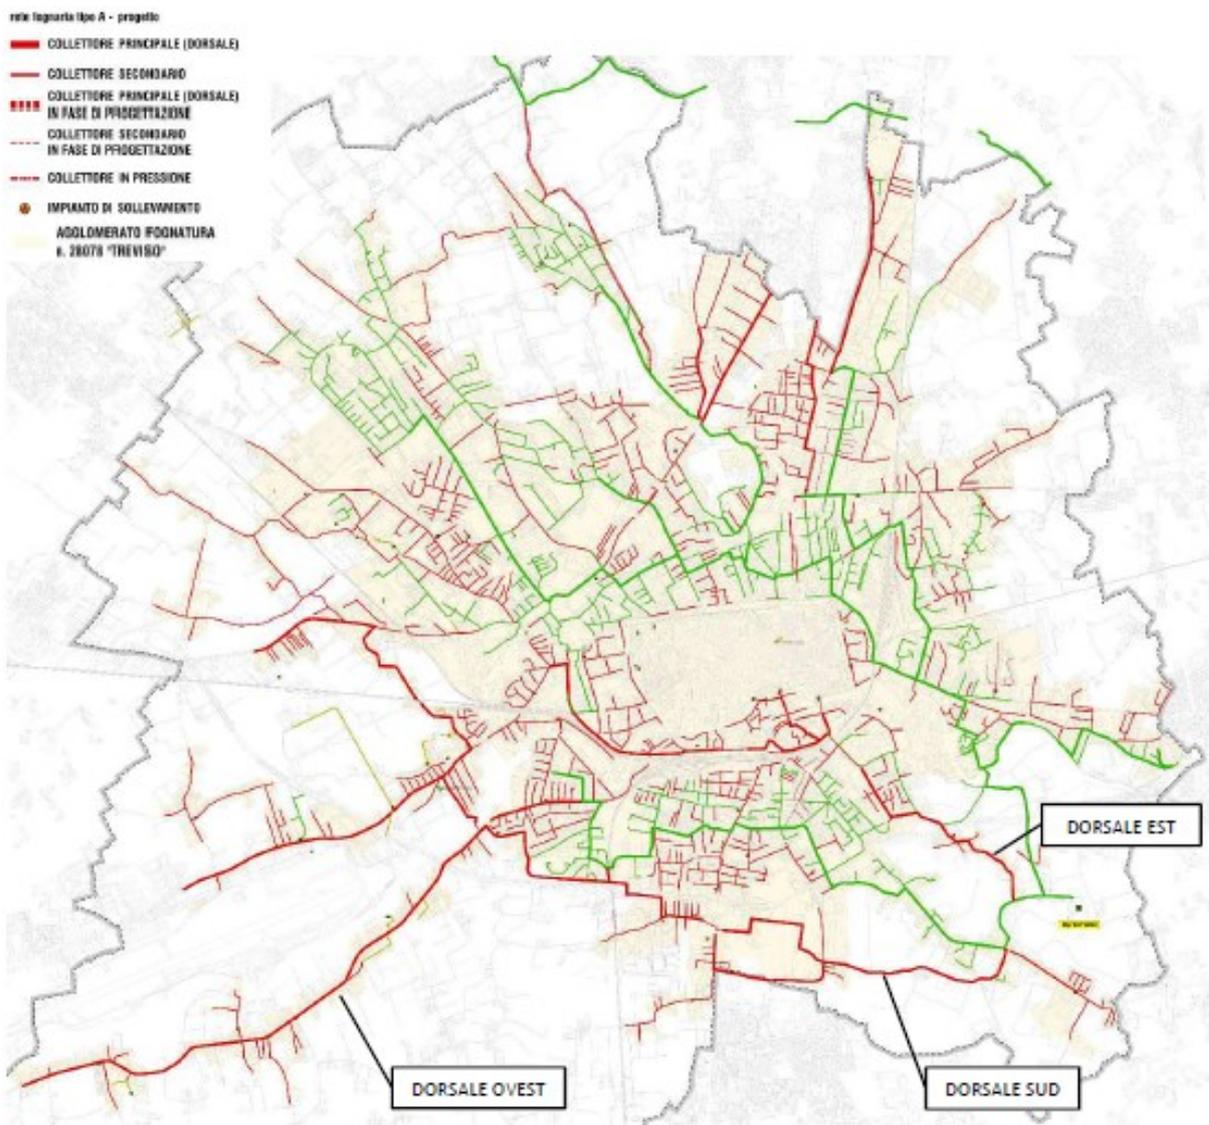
Planimetria di progetto rete fognaria nell'area esterna al centro storico.
